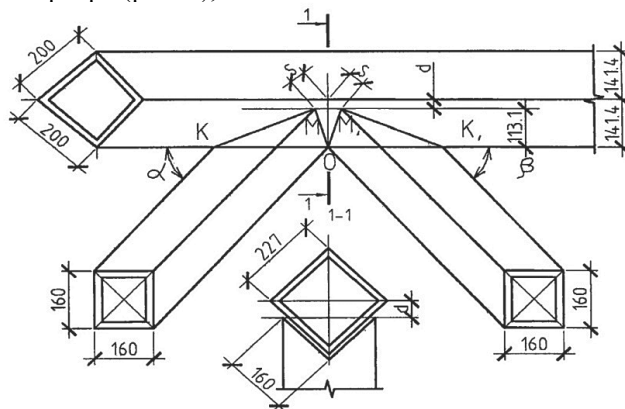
Узел примыкания раскосов к поясу у ферм из труб на ребро.
